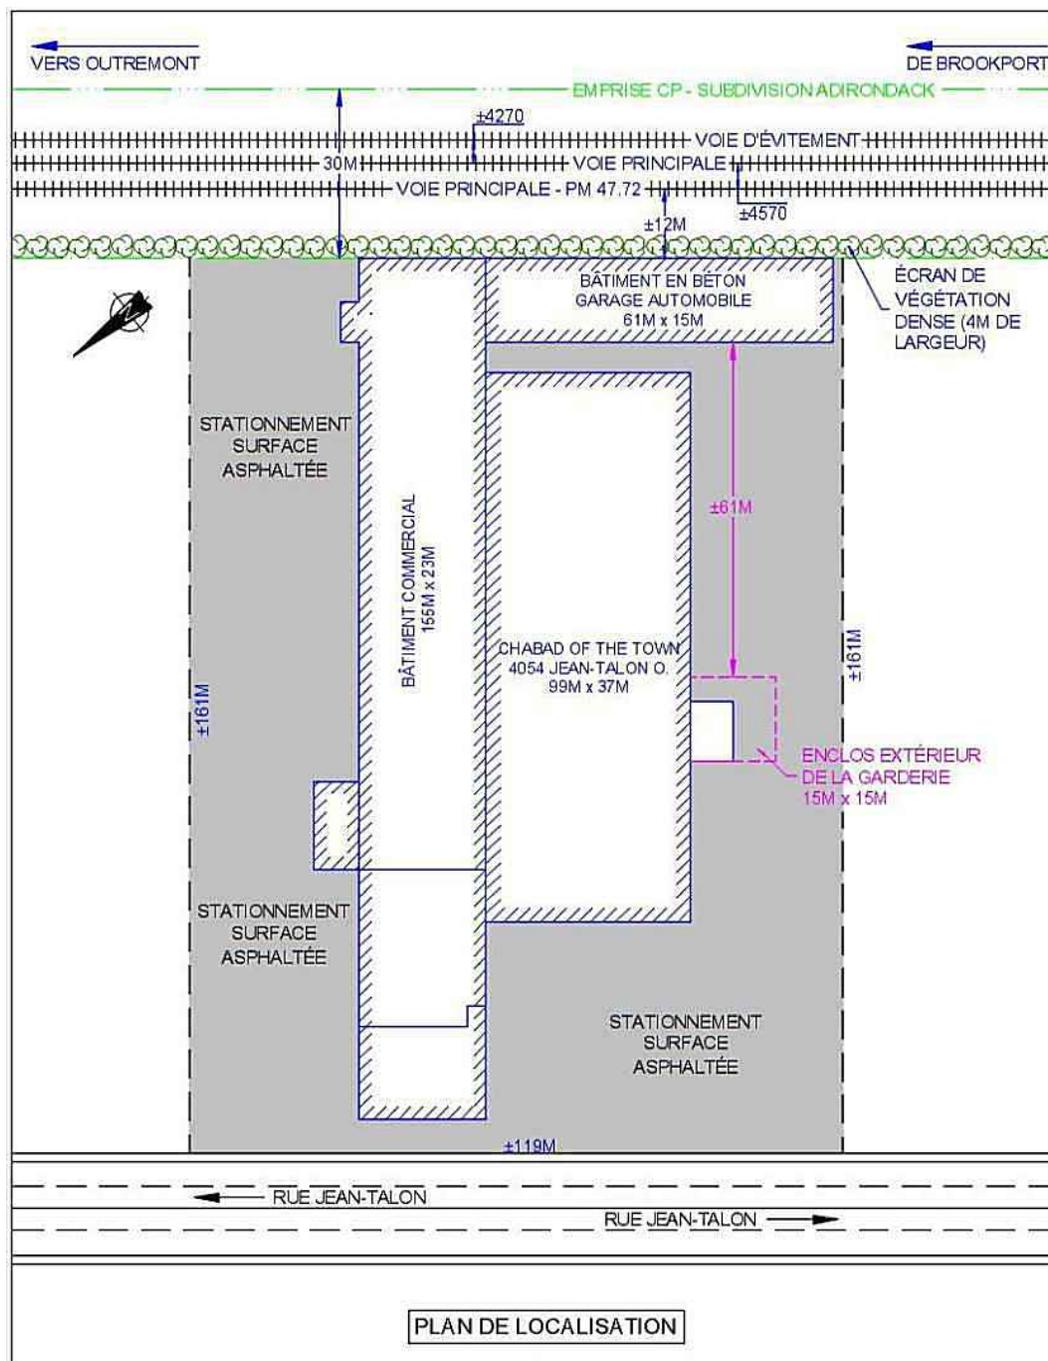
Plan de localisation du site de l'aménagement de la garderie.
